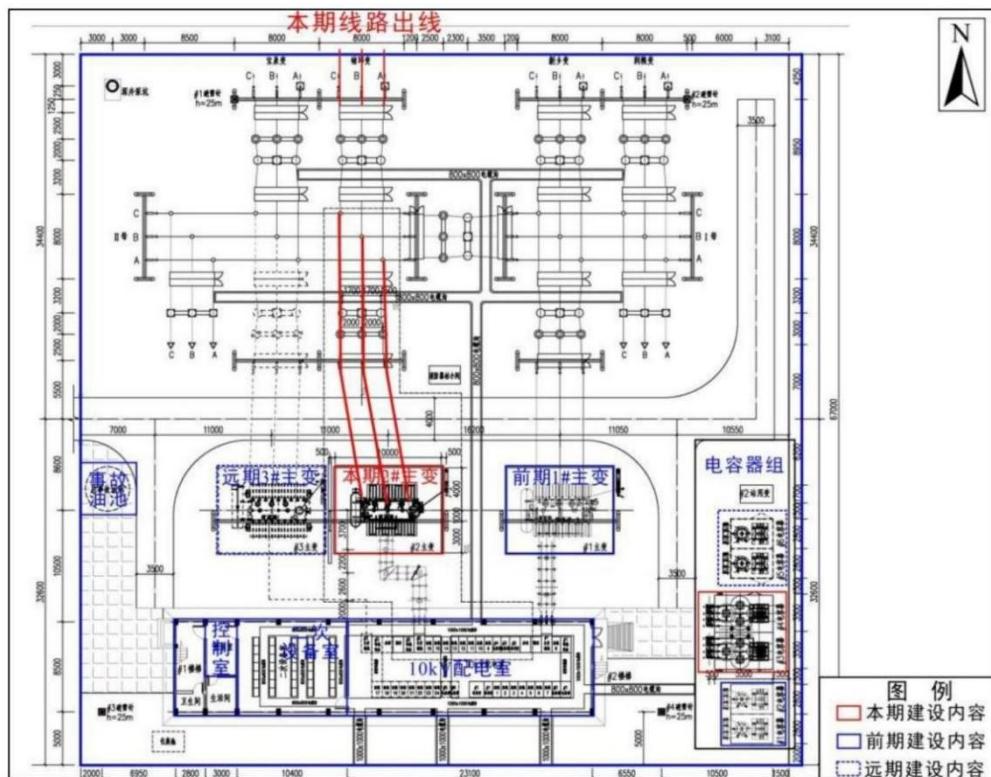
河南南阳市区顺达 110 千伏变电站平面布置示意图
